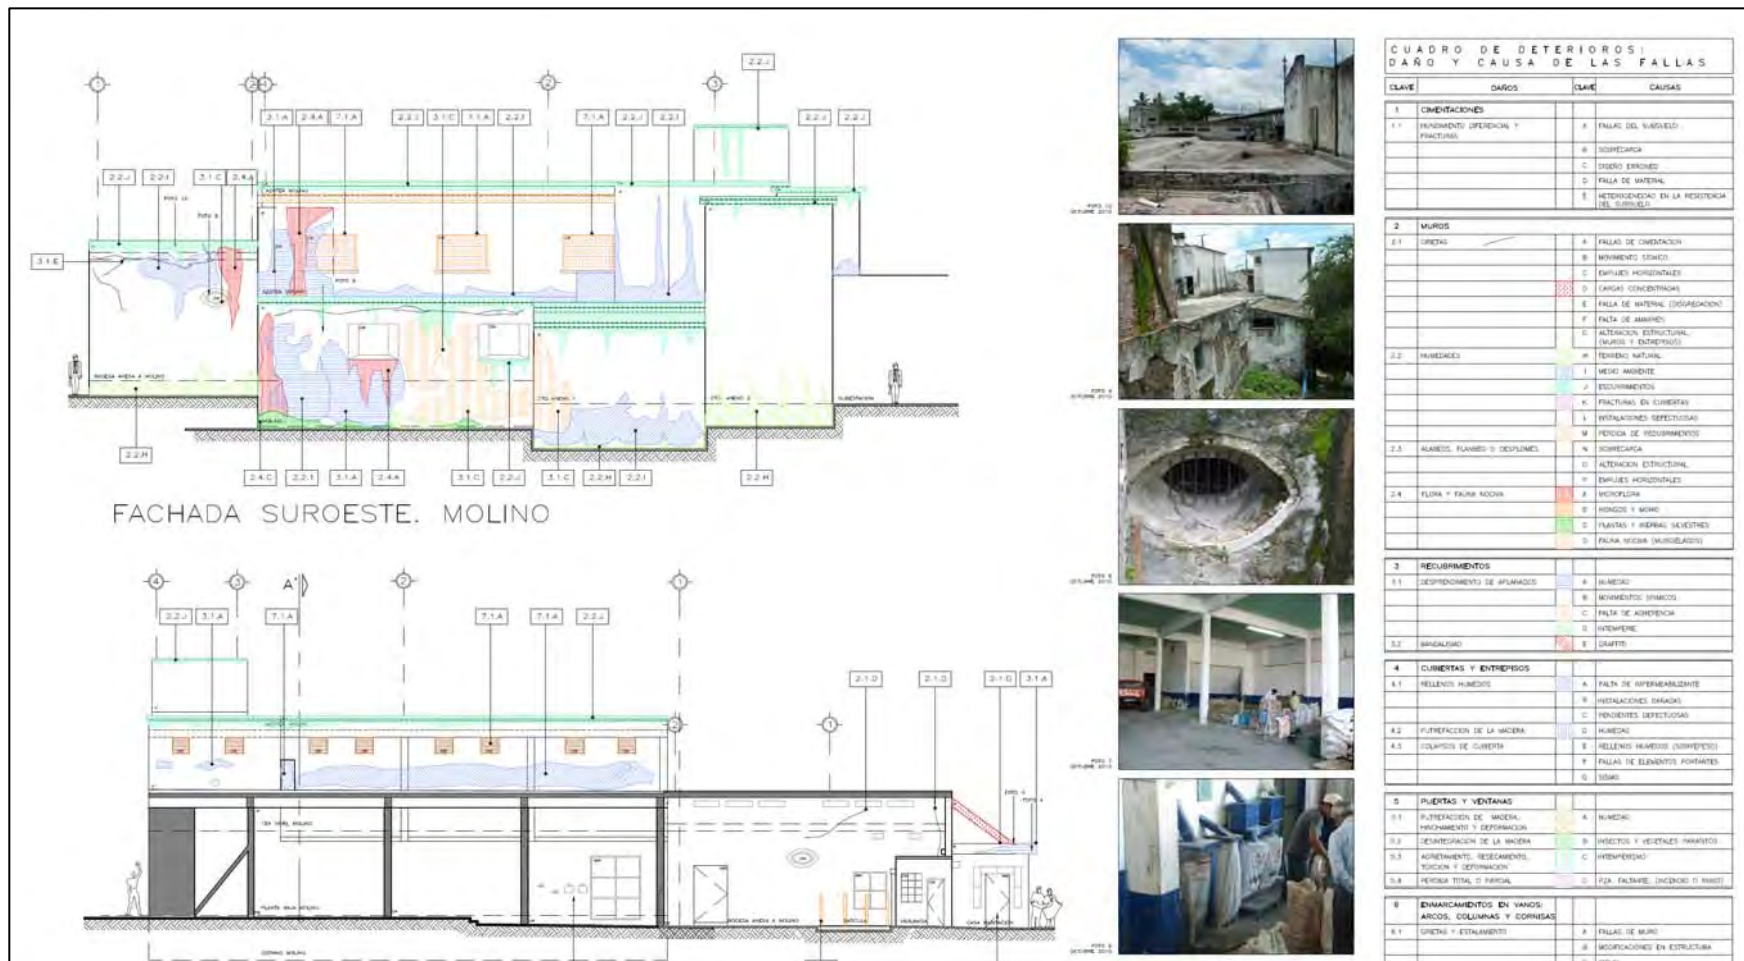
Plano de deterioros del molino de arroz, fachada suroeste. Dibujó IPV. 2011. (Ver planos en Anexos)
